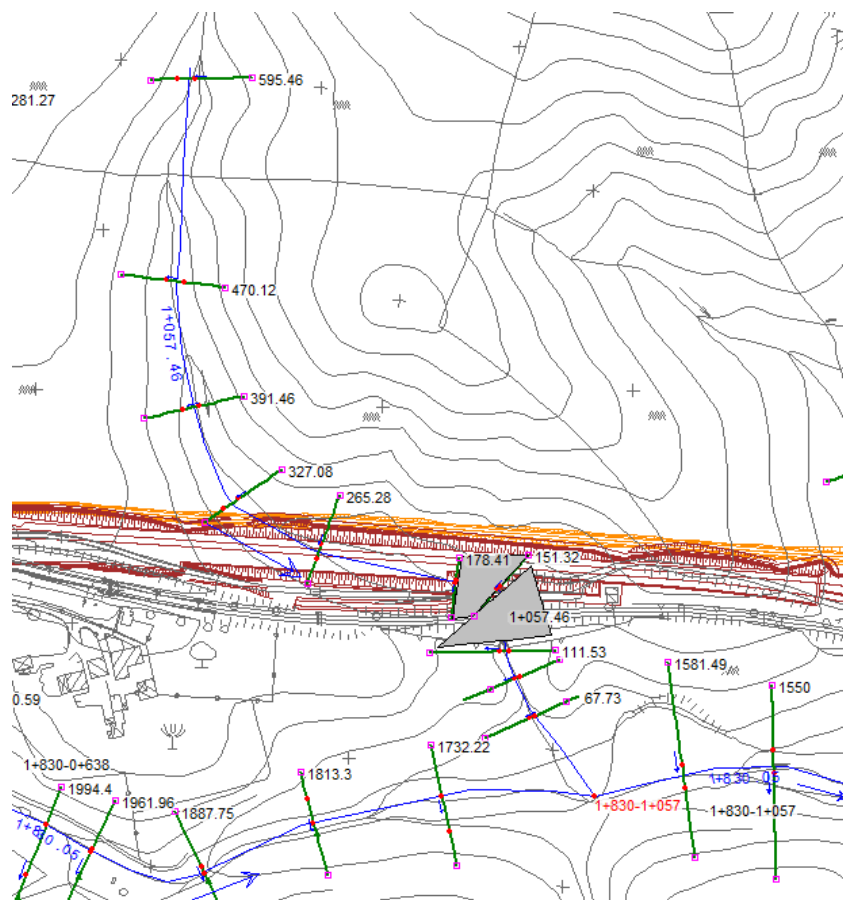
Planimetria Hec ras – sovrapposizione SDF – linea di progetto
